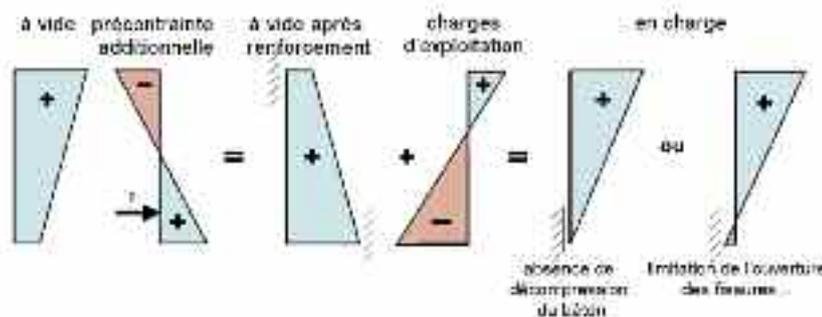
principe de renforcement d'une section non fissurée à vide
